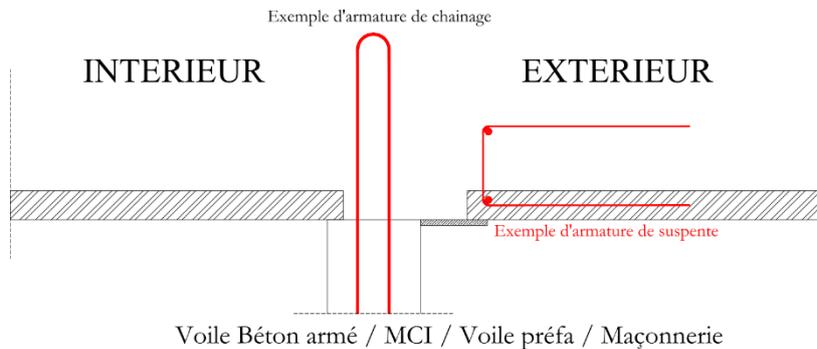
Détail avant mise en place des rupteurs et des aciers
